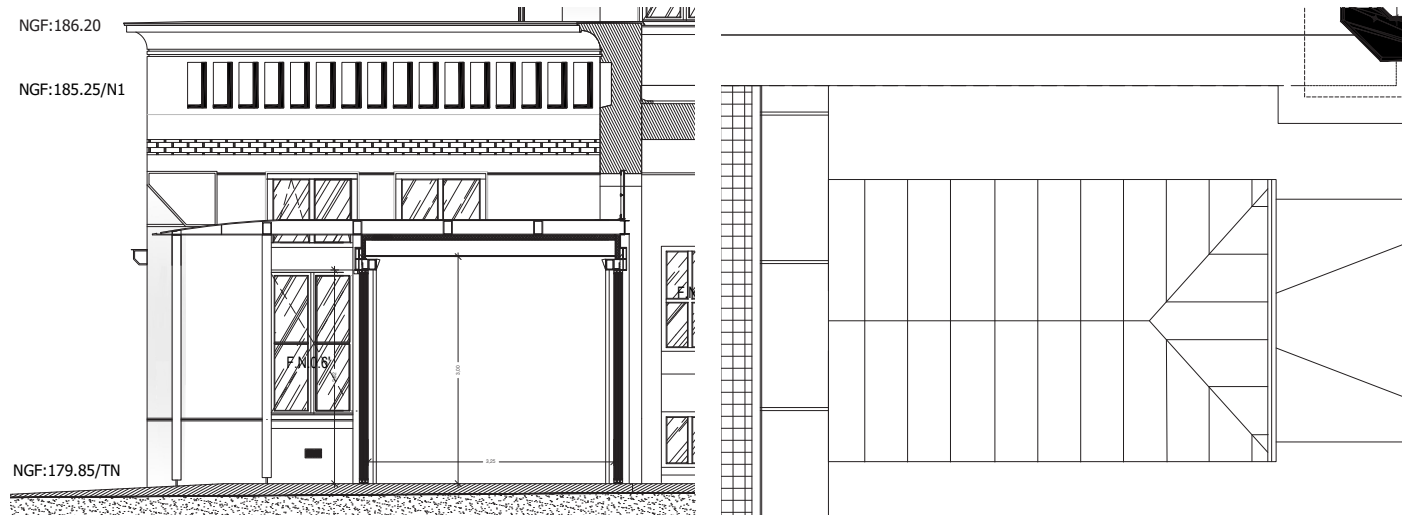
État projeté (APD) du lot couverture, plans, coupe et élévation Est du SAS thermique, pavillon A, Agence Goutal, 2024.
